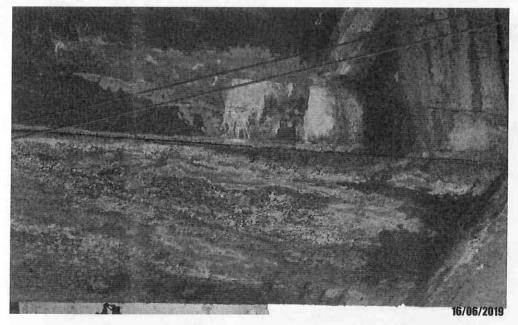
Detalhe de eflorescência e desplacamento de concreto.
